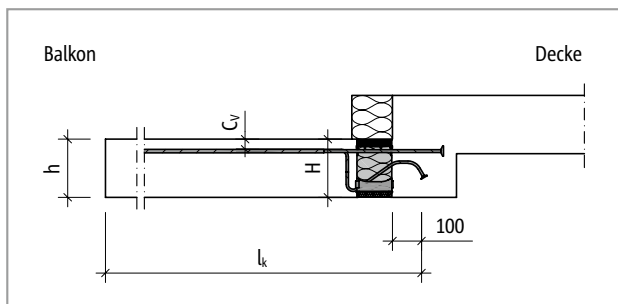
Schöck Isokorb® XT Typ K-U: Statisches System
